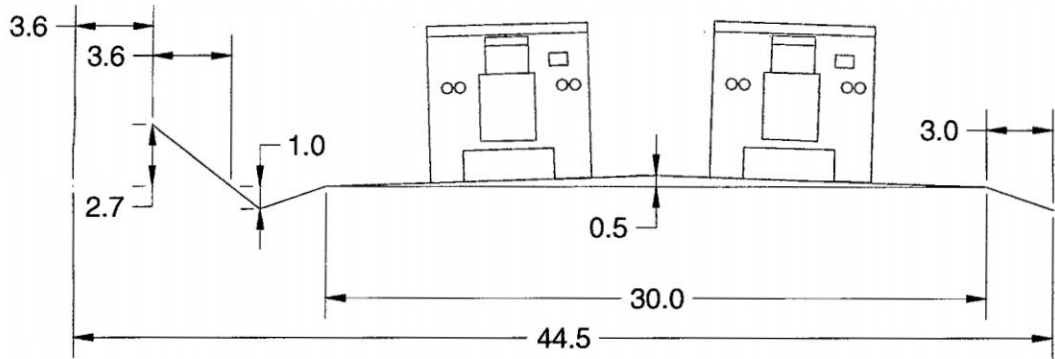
Ancho del camino o ruta de acarreo - corte
